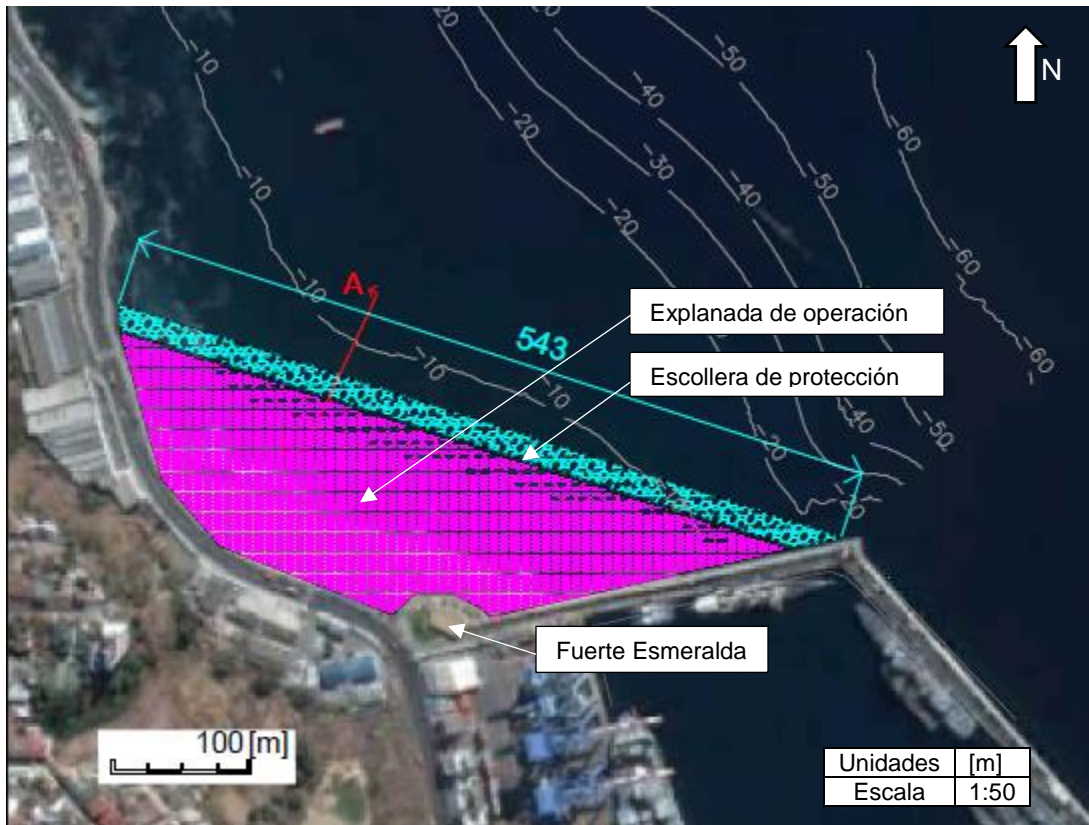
PLANO EN PLANTA DE ALTERNATIVA 1. FUENTE: ELABORACIÓN PROPIA CON DATOS DE (GOOGLE, 2017).
